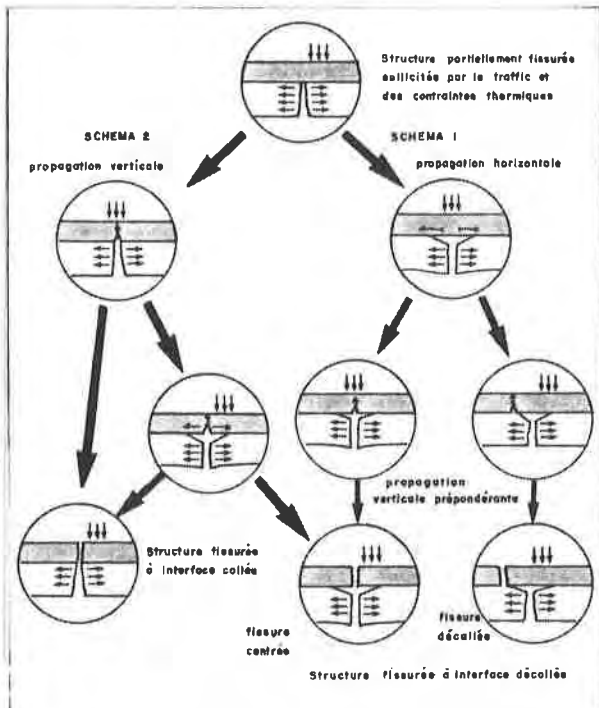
Mécanisme de fissuration d'une structure de chaussée : cheminements types.
